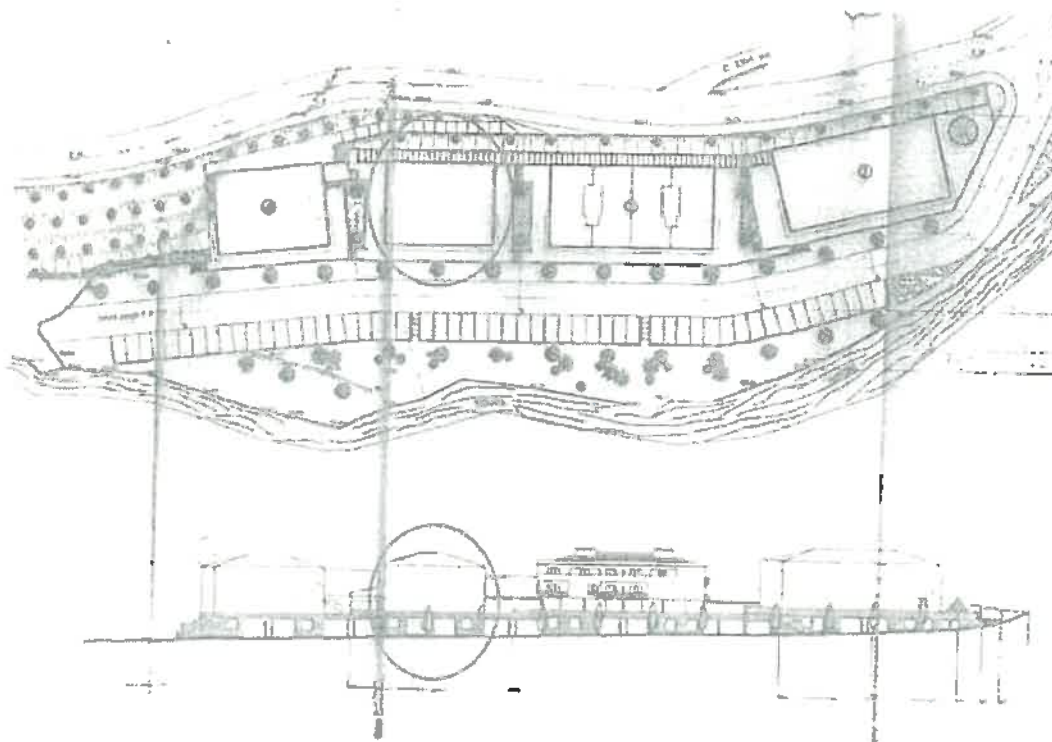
Extrato da planta do pretendo loteamento, com LOTE 3 assinalado
